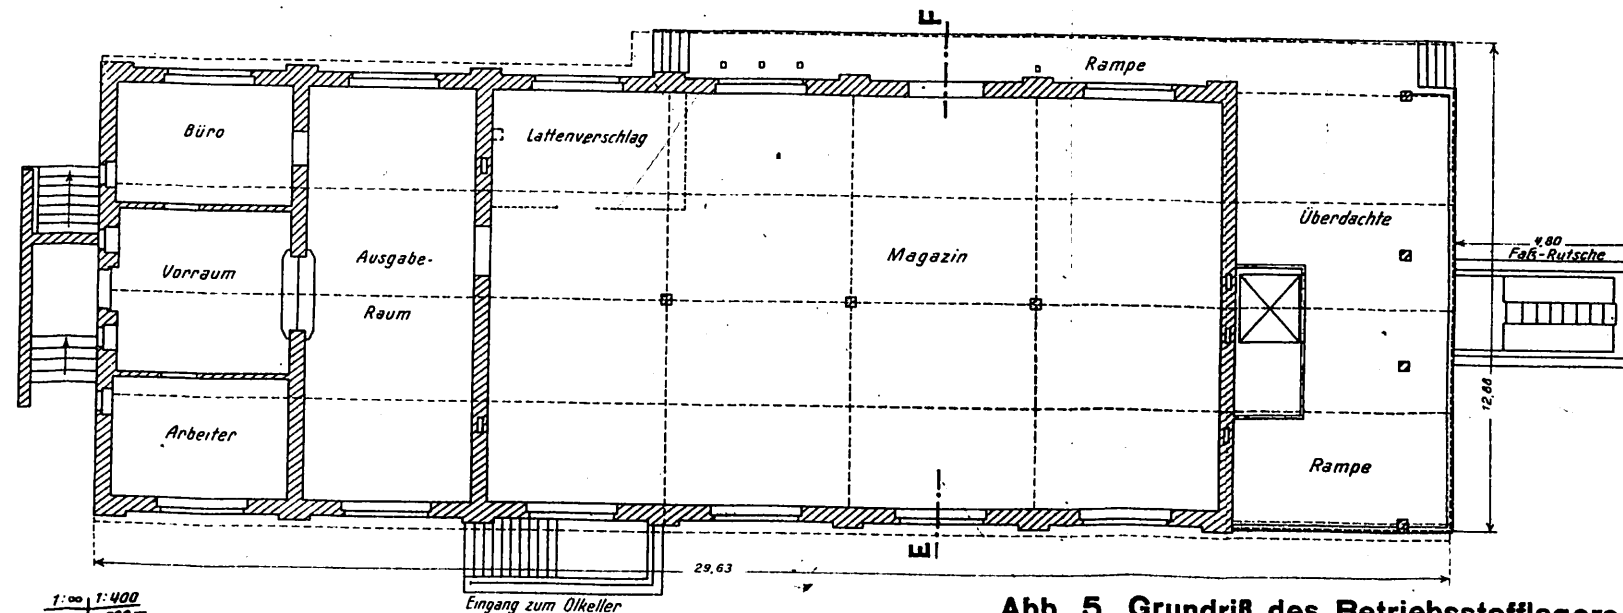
Grundriß des Betriebsstofflagers (Erdgeschoß) M.1: 200.
